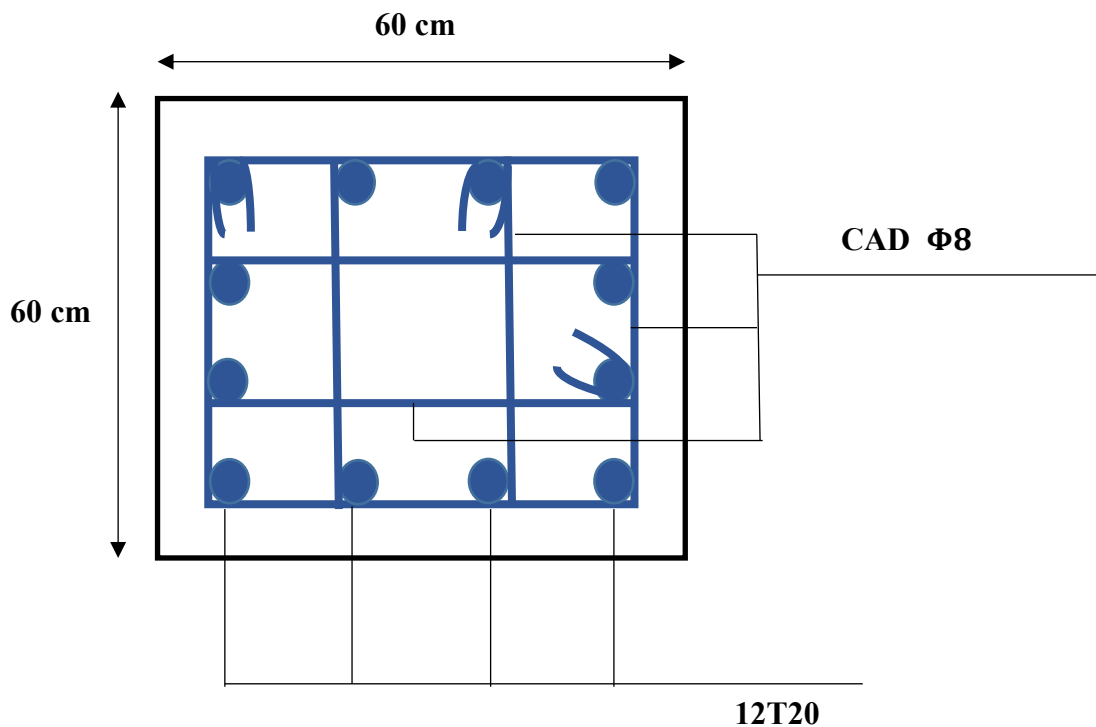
ferrailage des poteaux des sous-sol (60x60) cm²
